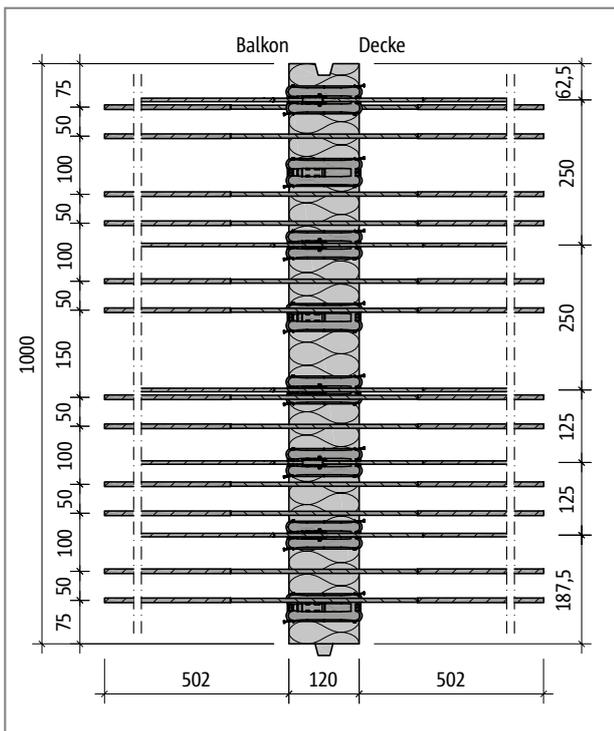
Schöck Isokorb® Typ KXT40: Produktgrundriss
